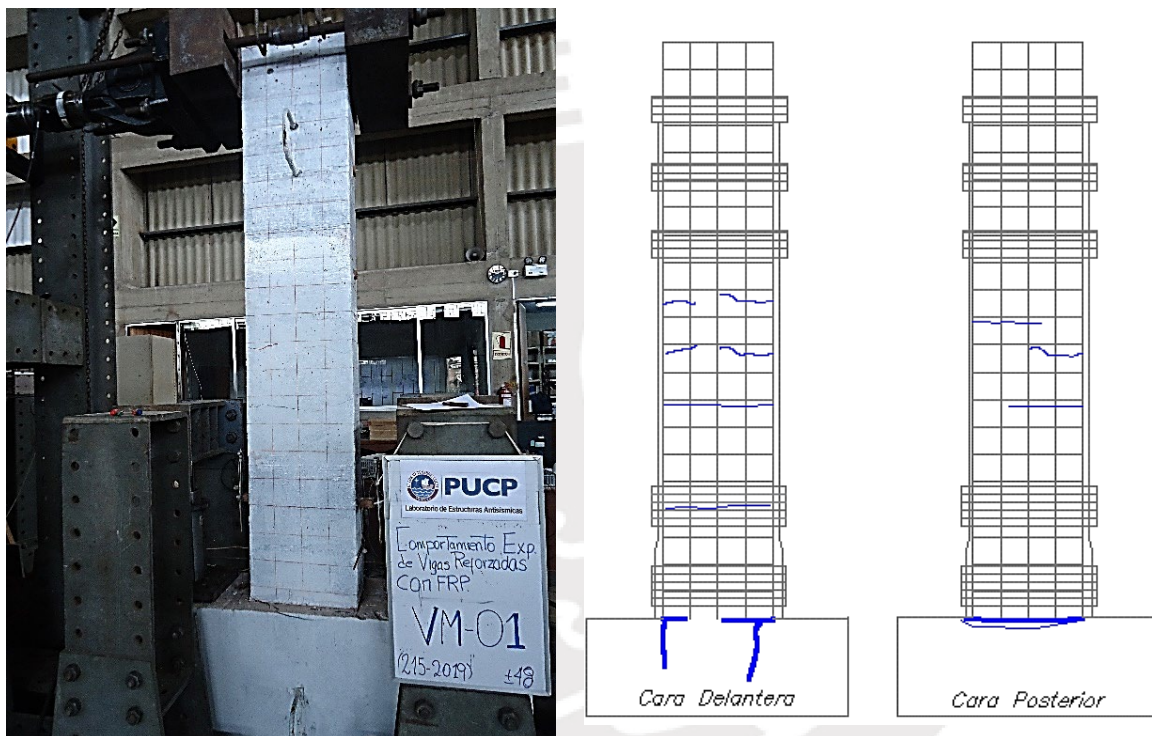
Mapa de fisuras de la viga VM-01
